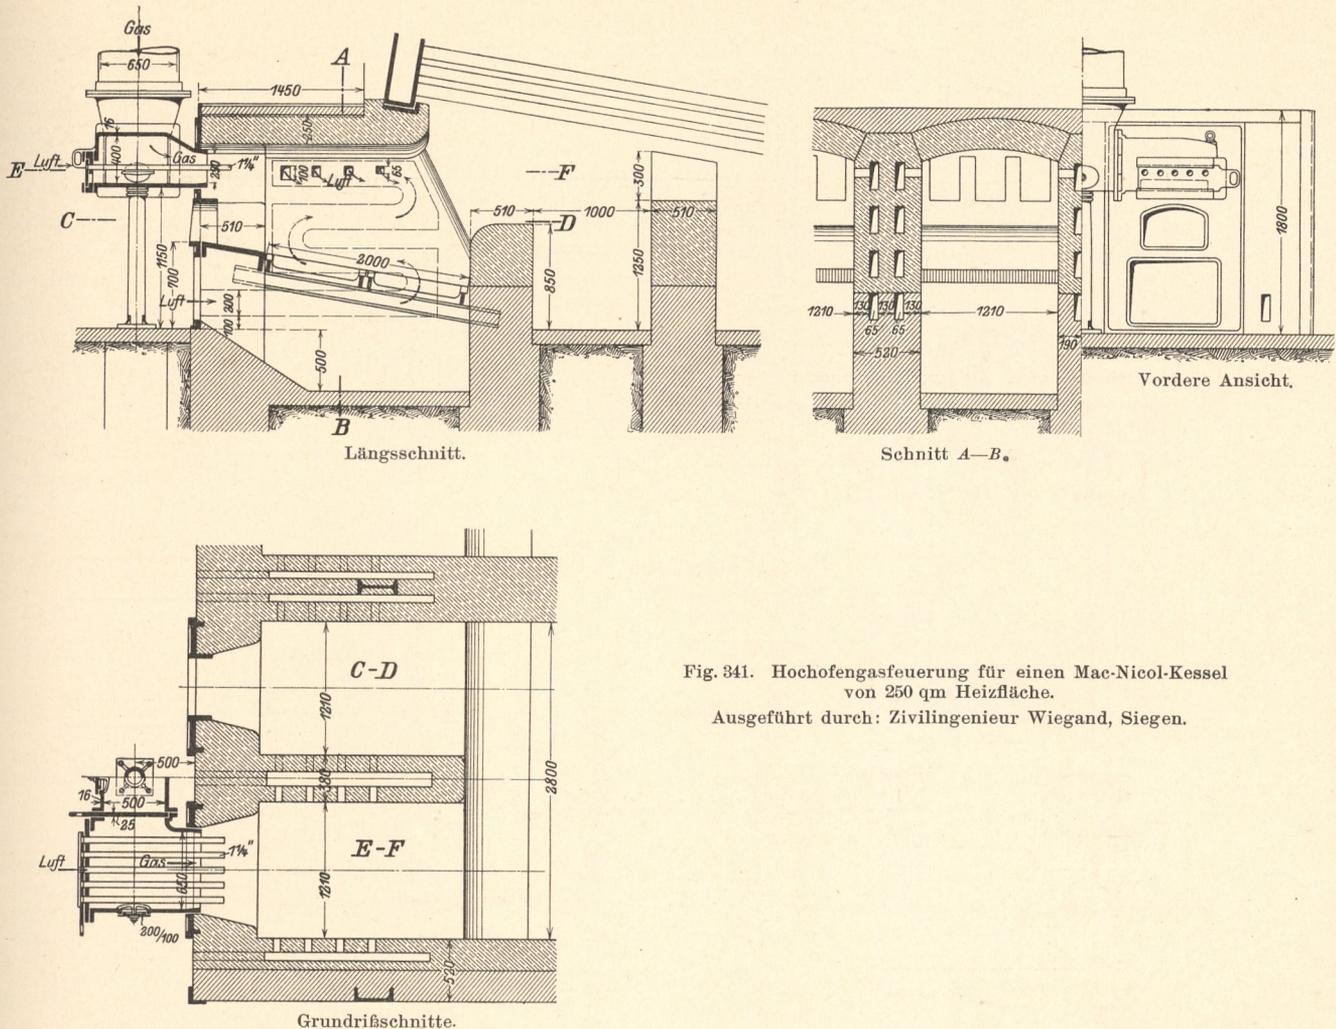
Hochofengasfeuerung für einen Mac-Nicol-Kessel von 250 qm Heizfläche.
